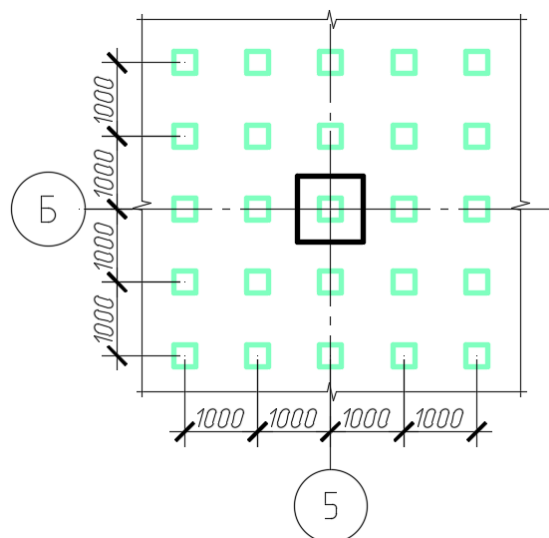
Схема расположения свай под фрагмент плитного фундамента
